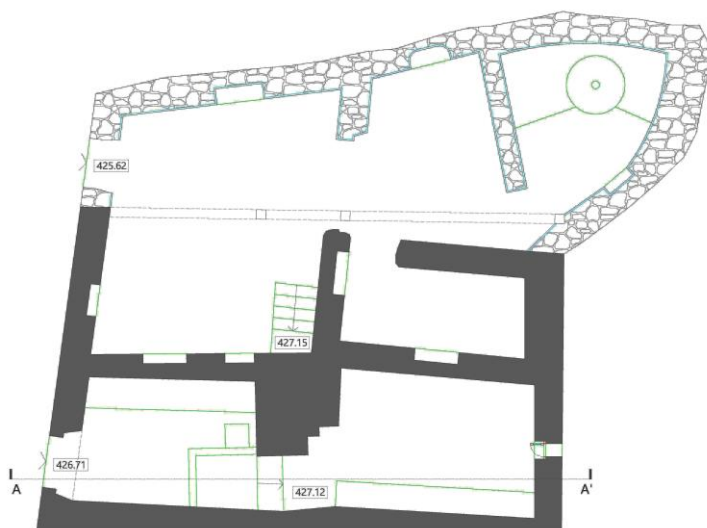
Casa 1: Planta do Existente – R/Chão.
